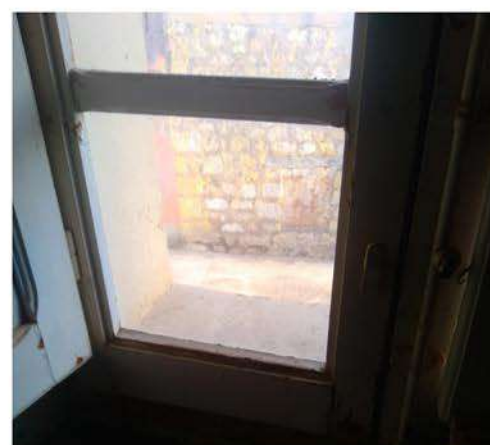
Imagen de la ventana de madera de la planta superior del fachada norte Fuente: Foto propia
